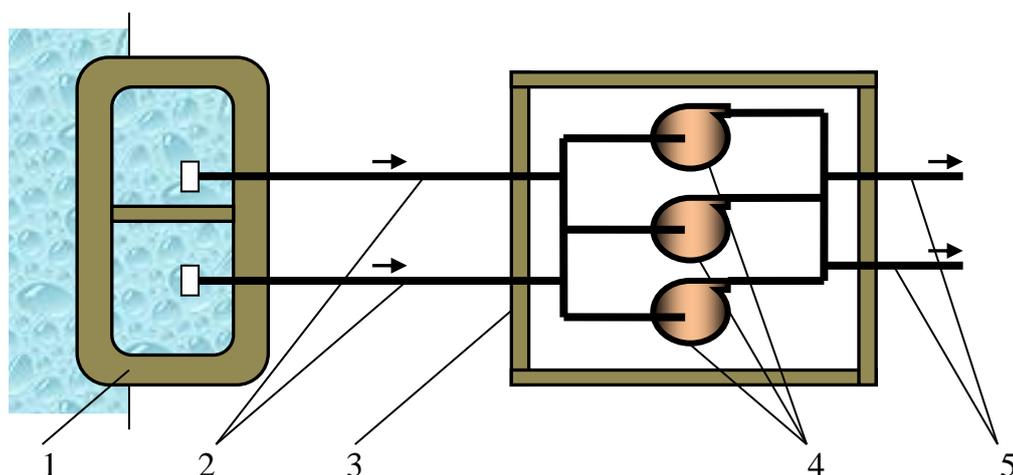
Схема насосной станции I подъема: 1 – водоприемник; 2 - всасывающий трубопровод; 3 – насосная станция; 4 – насосные агрегаты; 5 – напорный трубопровод.
